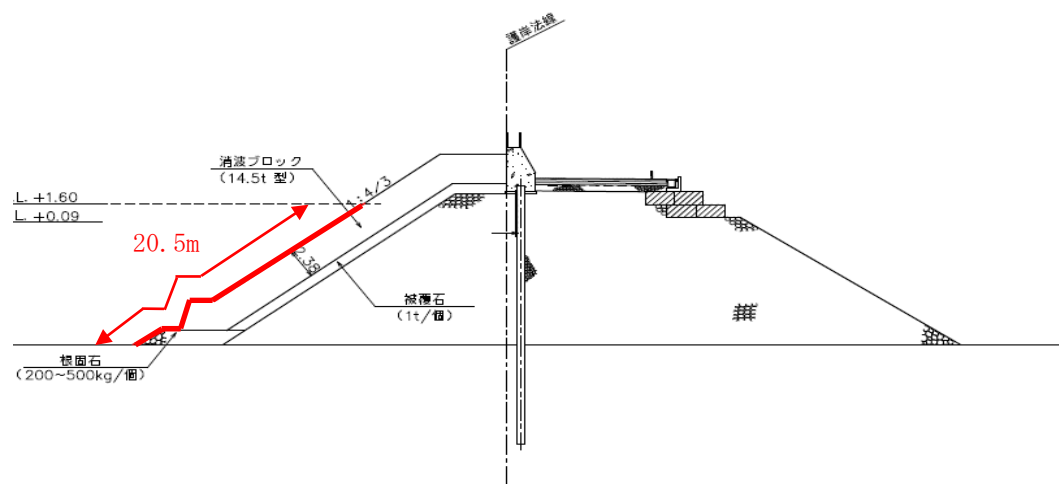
揚灰取付護岸 断面 1 (標準断面 3)
